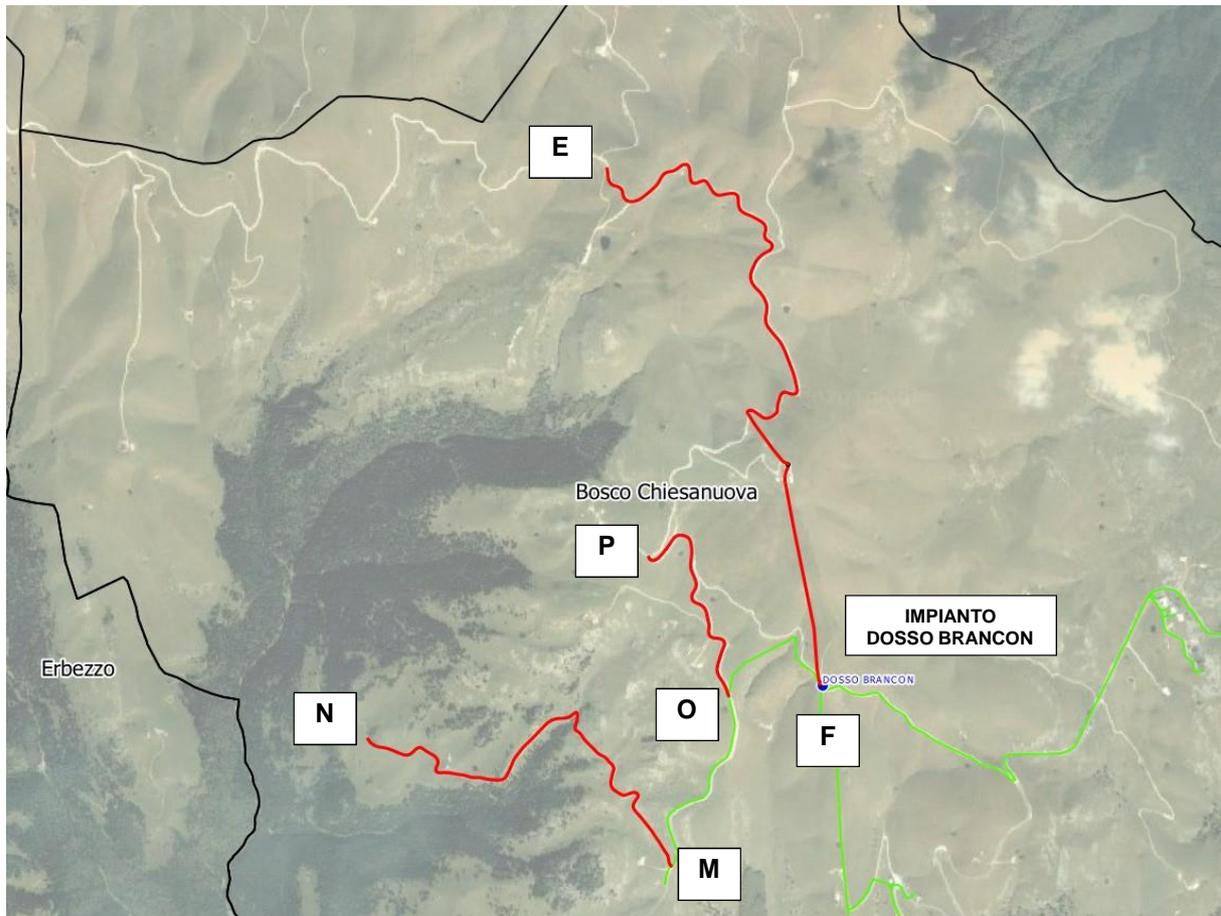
Planimetria generale dei tracciati EF, MN e OP. In rosso i tracciati di progetto, in verde la rete esistente.
